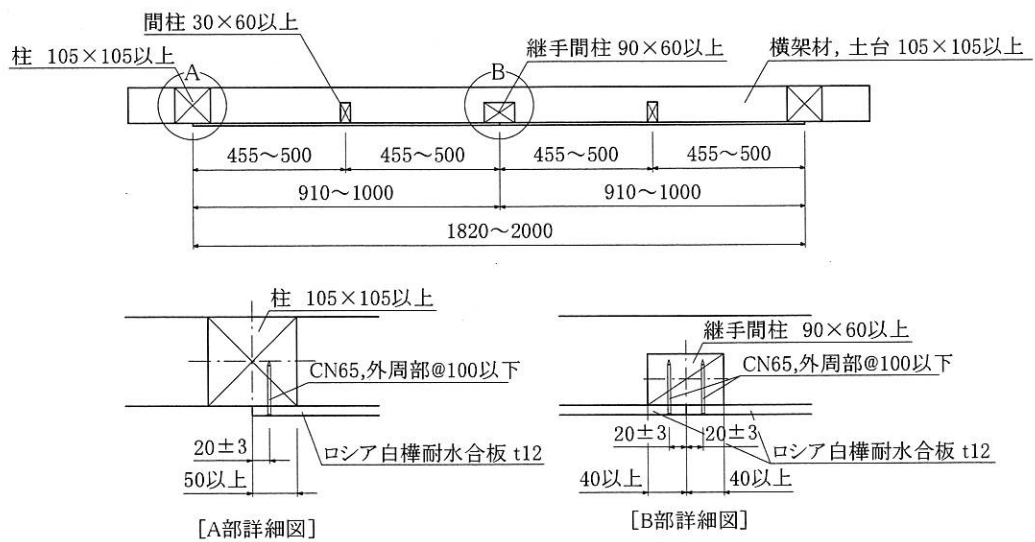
施工図 [水平断面] (寸法単位 : mm)
